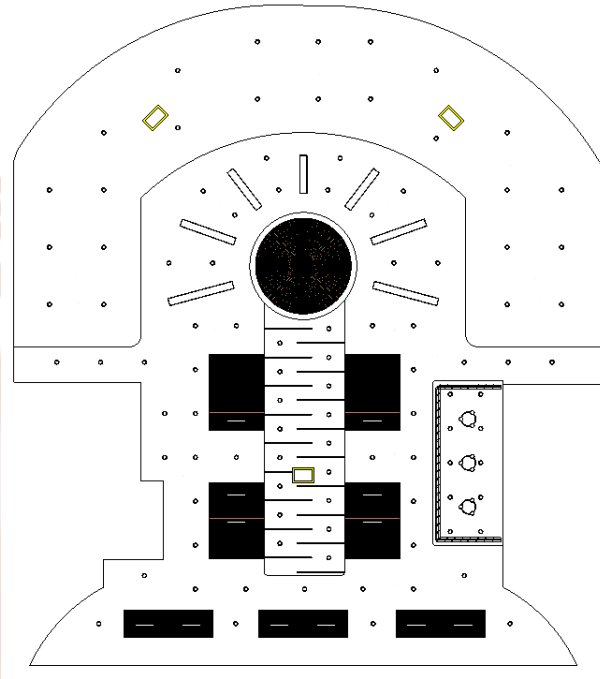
Alternatif 2 Rencana Dinding *Suite Room
